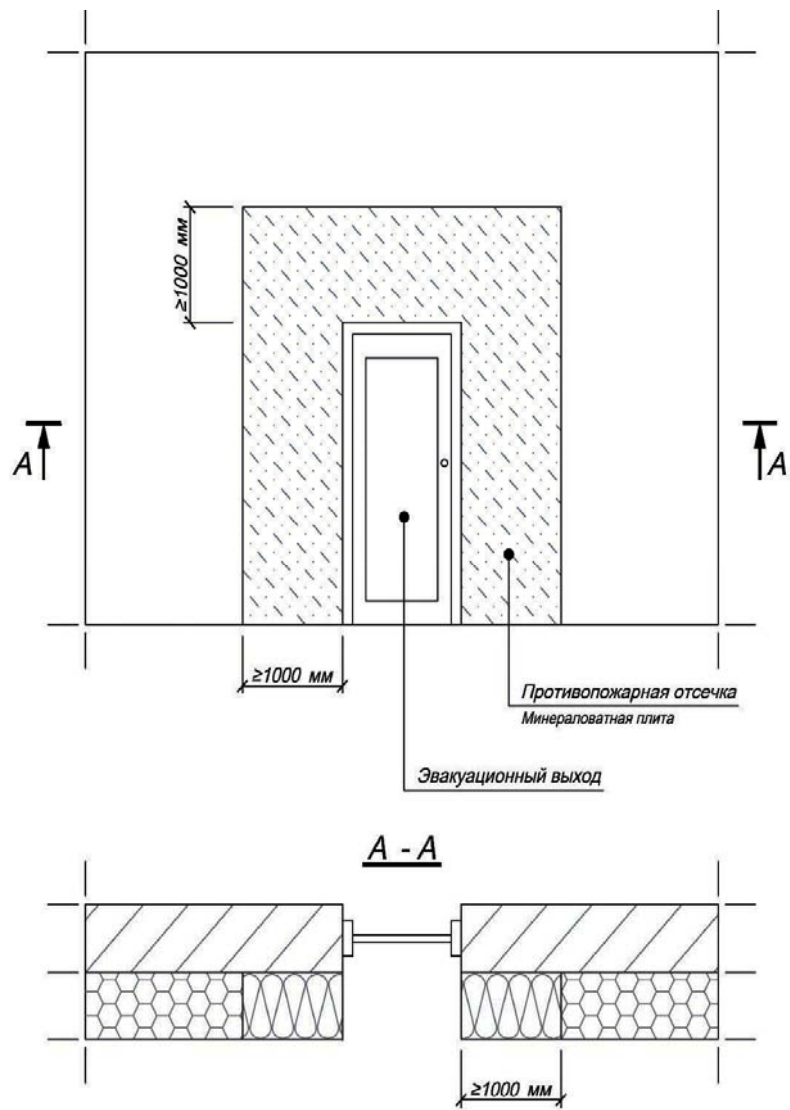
Участки наружных стен по периметру эвакуационных выходов из здания.
